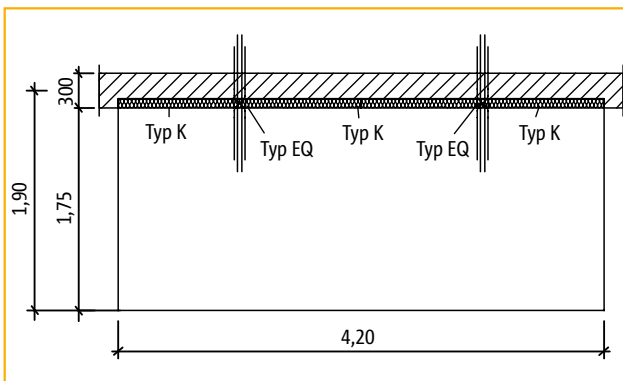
Anordnung der Isokorb® Elemente im Grundriss
